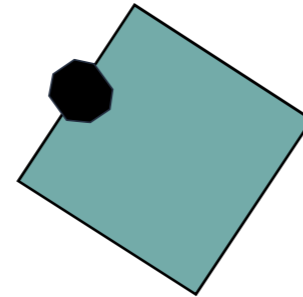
Croquis en planta del Faro de Punta Cabalo
